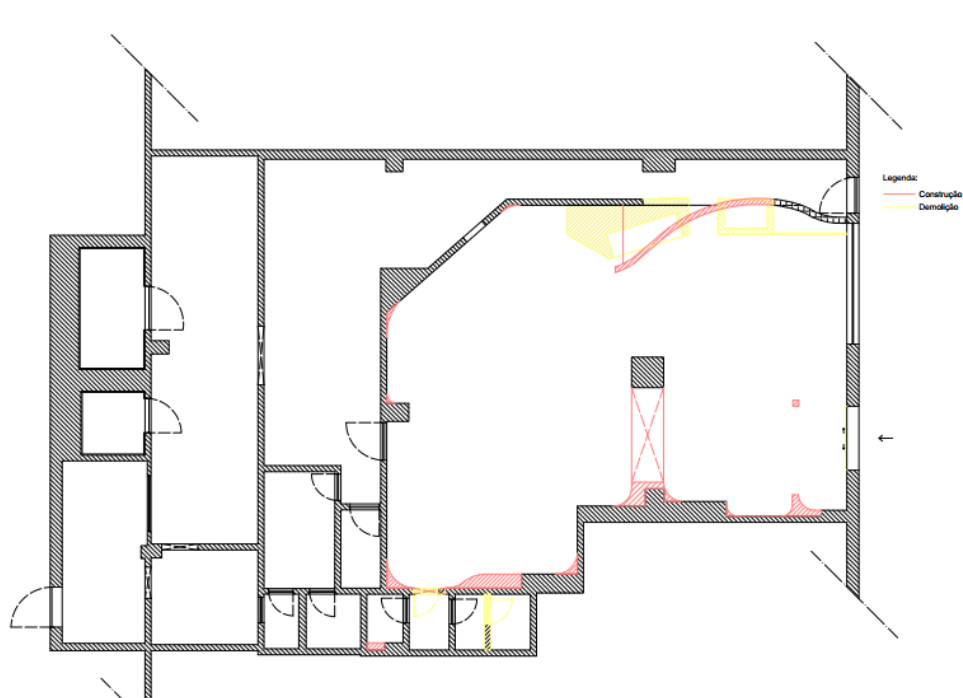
Planta de Alterações. Fonte: Autora, 2025
